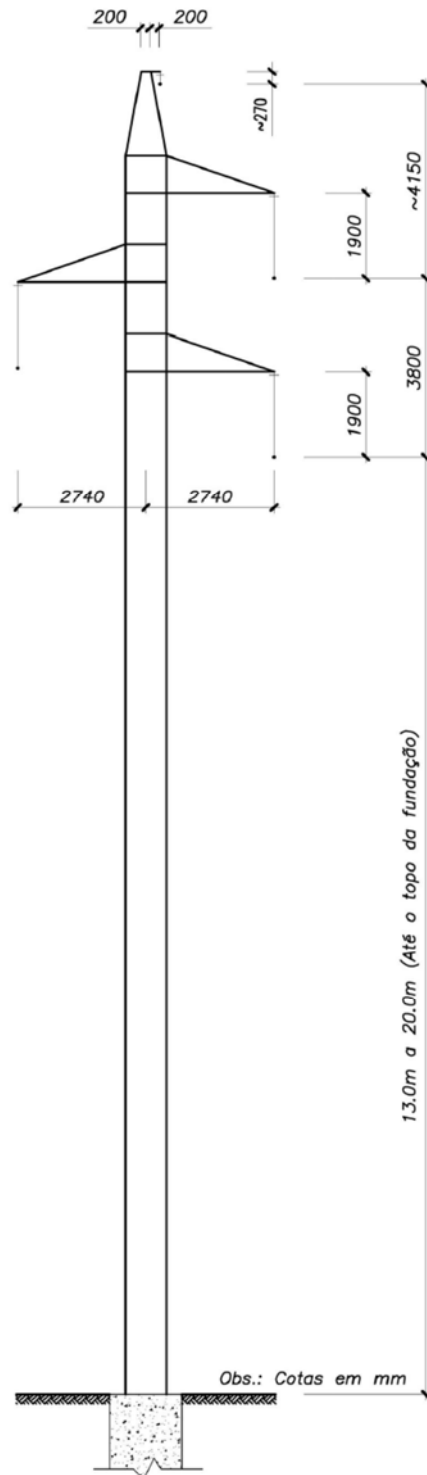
TRUSSPOLE TIPO MKSS1 – Silhueta típica.
